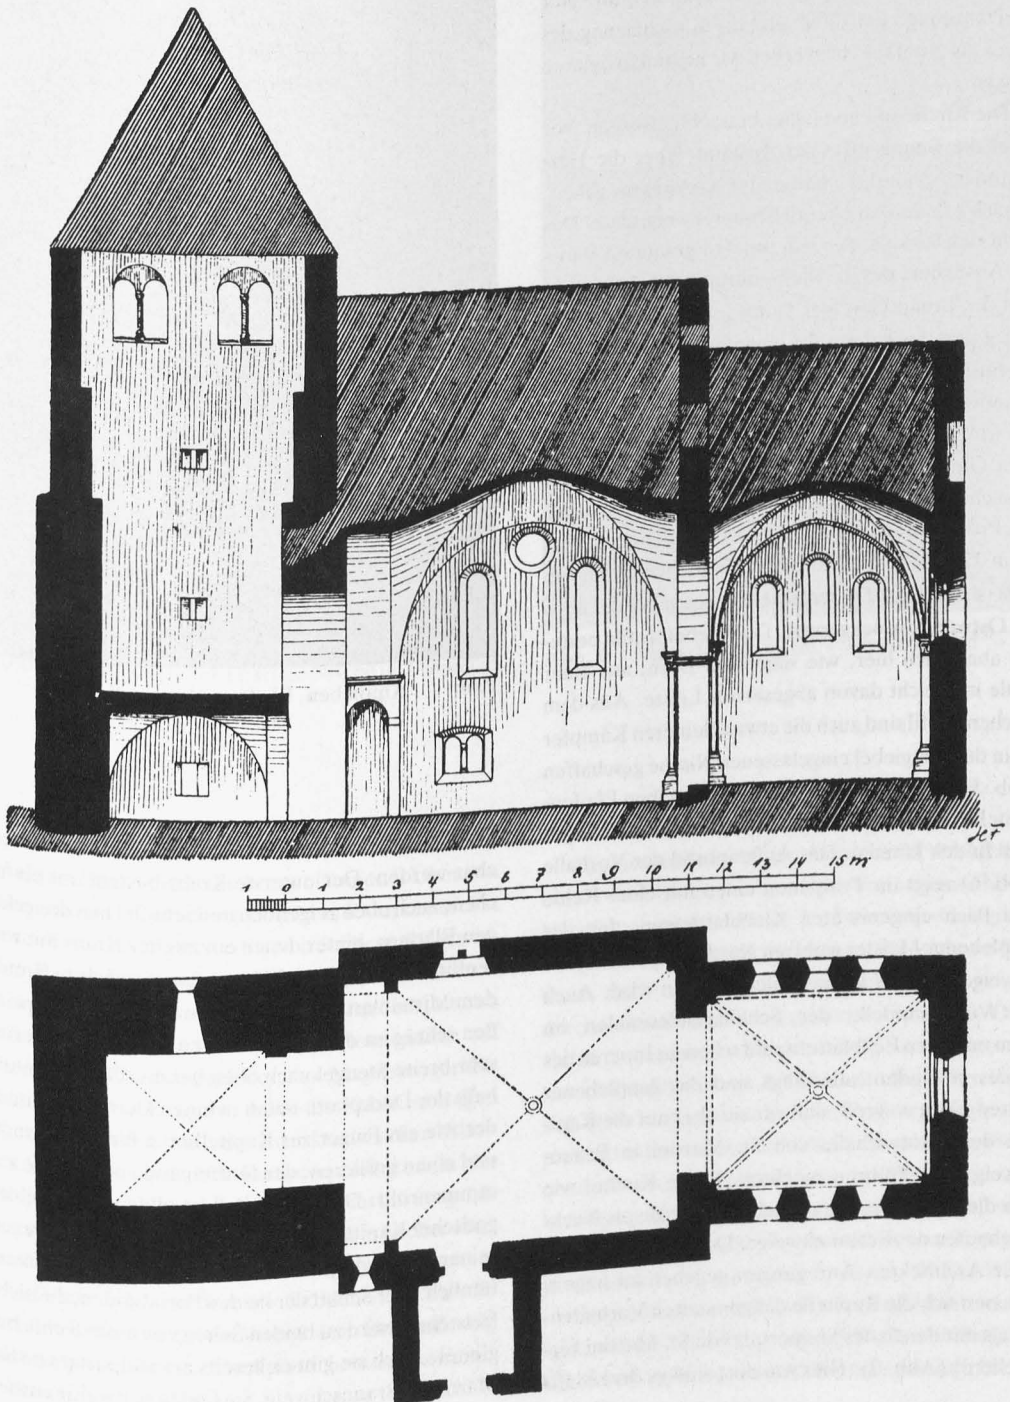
Ampleben, Längsschnitt und Grundriß der Kirche
